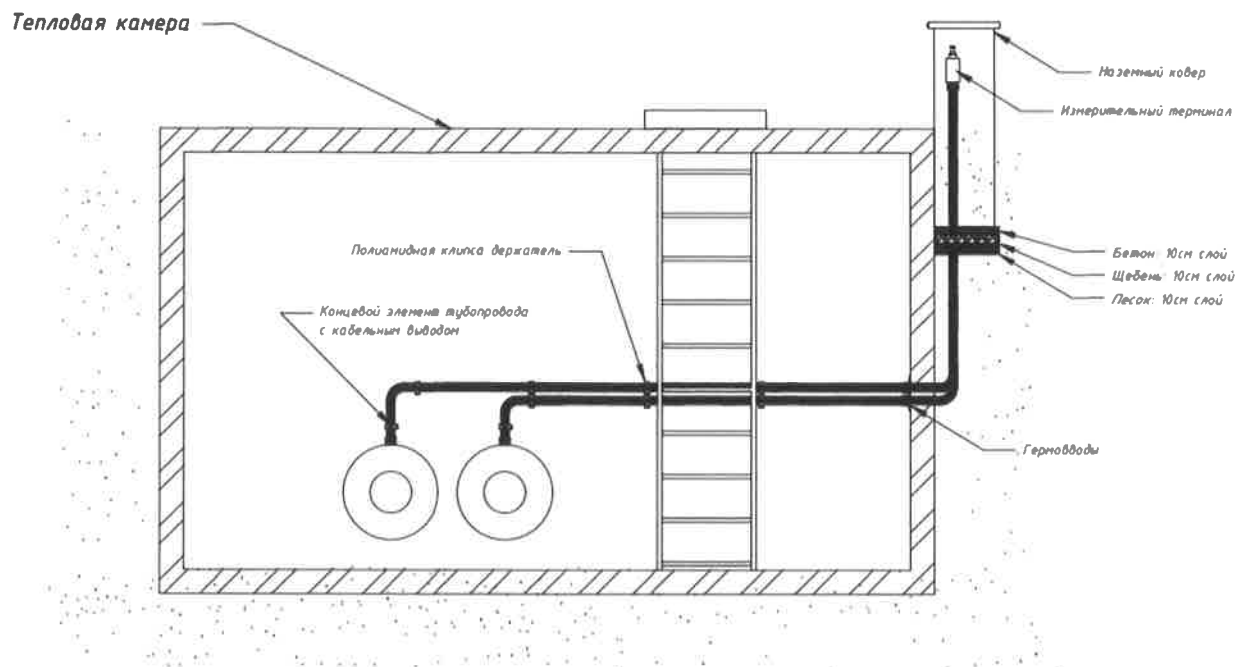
Прокладка кабеля КСДК в тепловой камере
